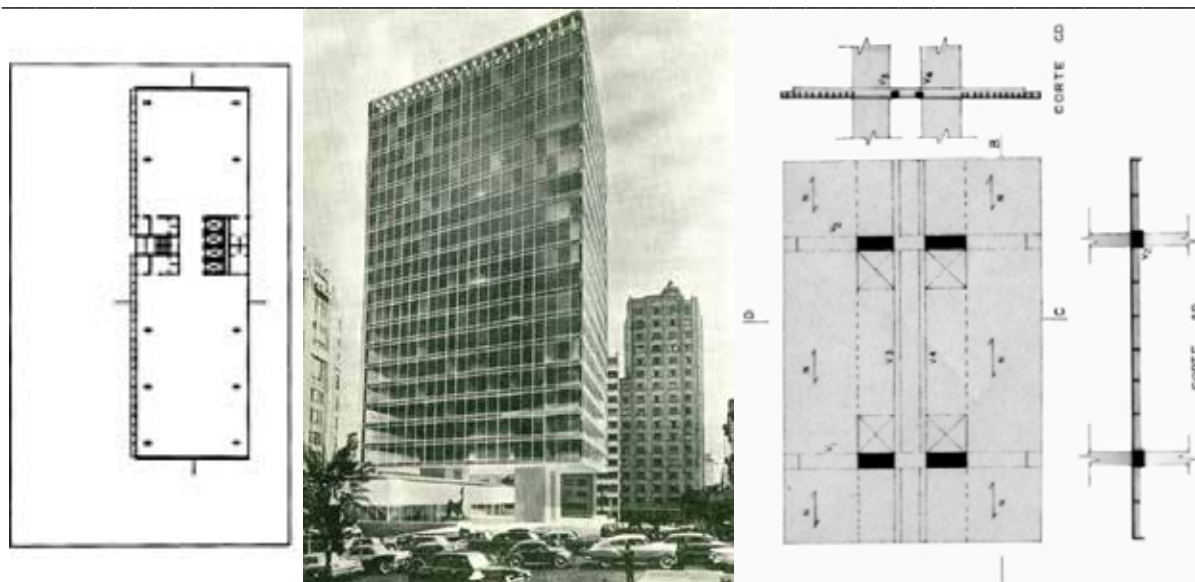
Pedro Paulo de Mello Saraiva e Miguel Juliano e Silva: Edifício V Avenida (1959); prisma de base retangular estruturado por duas linhas de sete apoios, de modo a permitir amplos balanços laterais. Planta pavimento tipo.
